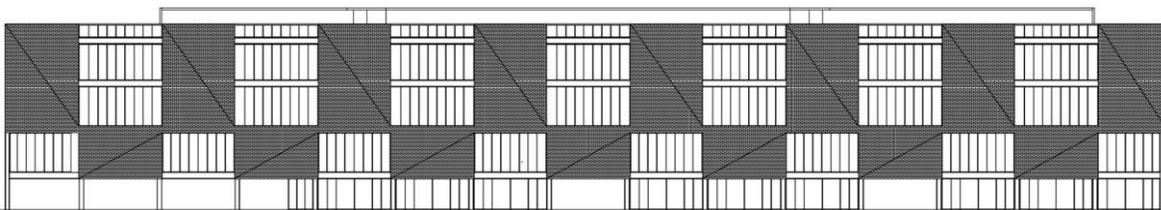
Fachada calle 9 – EDIFICIO CREATIVO
